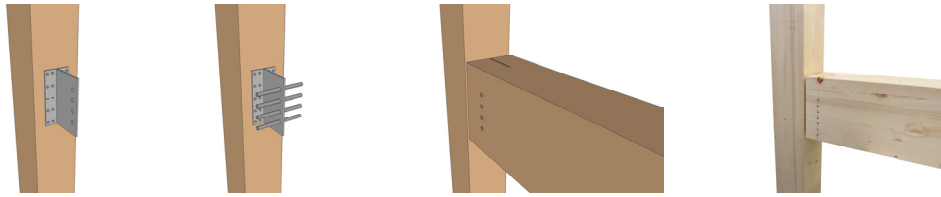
Ligação viga-pilar sujeita a esforço transverso (tensões perpendiculares às fibras na viga).
